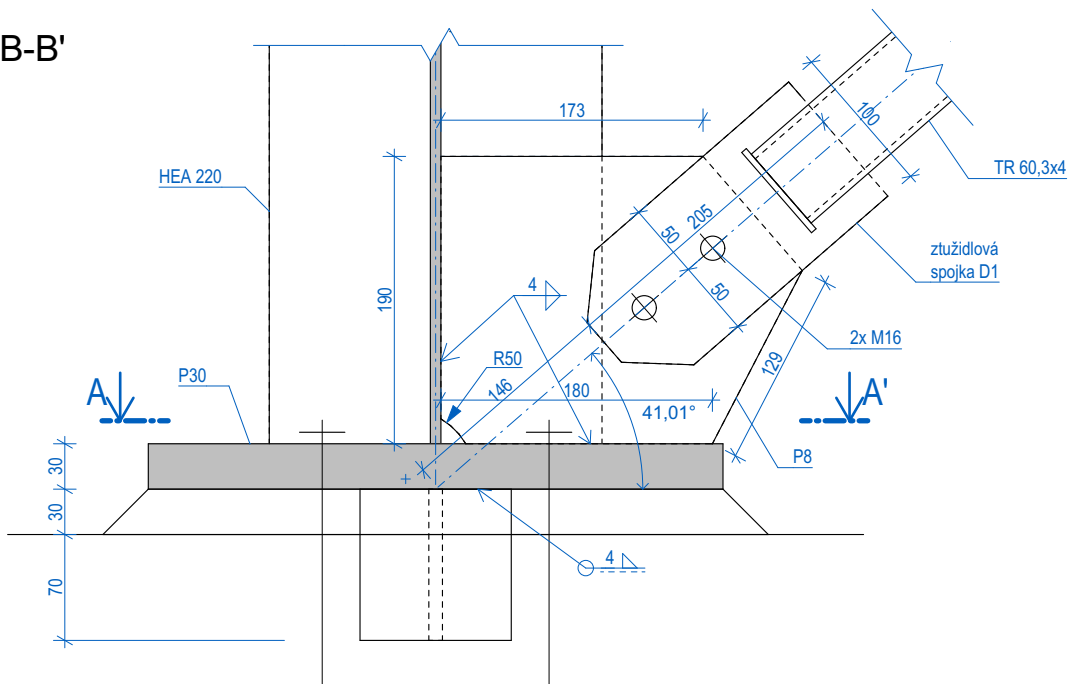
PATKA SLOUPU ZÁKLADNÍ VAZBY, M=1:5
